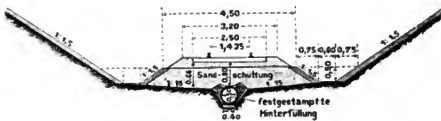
Entwässerung des Planums bei tonigem Auftrag. M. 1 : 16.
